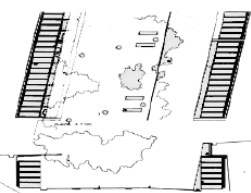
Plantas y cortes (Cementerio de Igualada).
